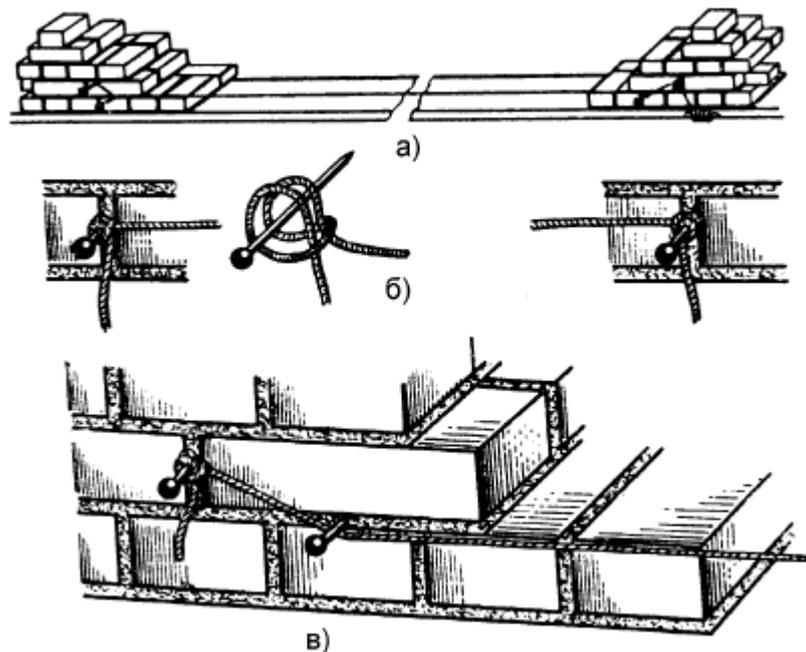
а - общий вид натянутой причалки, б - закрепление причалки двойной петлей, в - натягивание причалки
